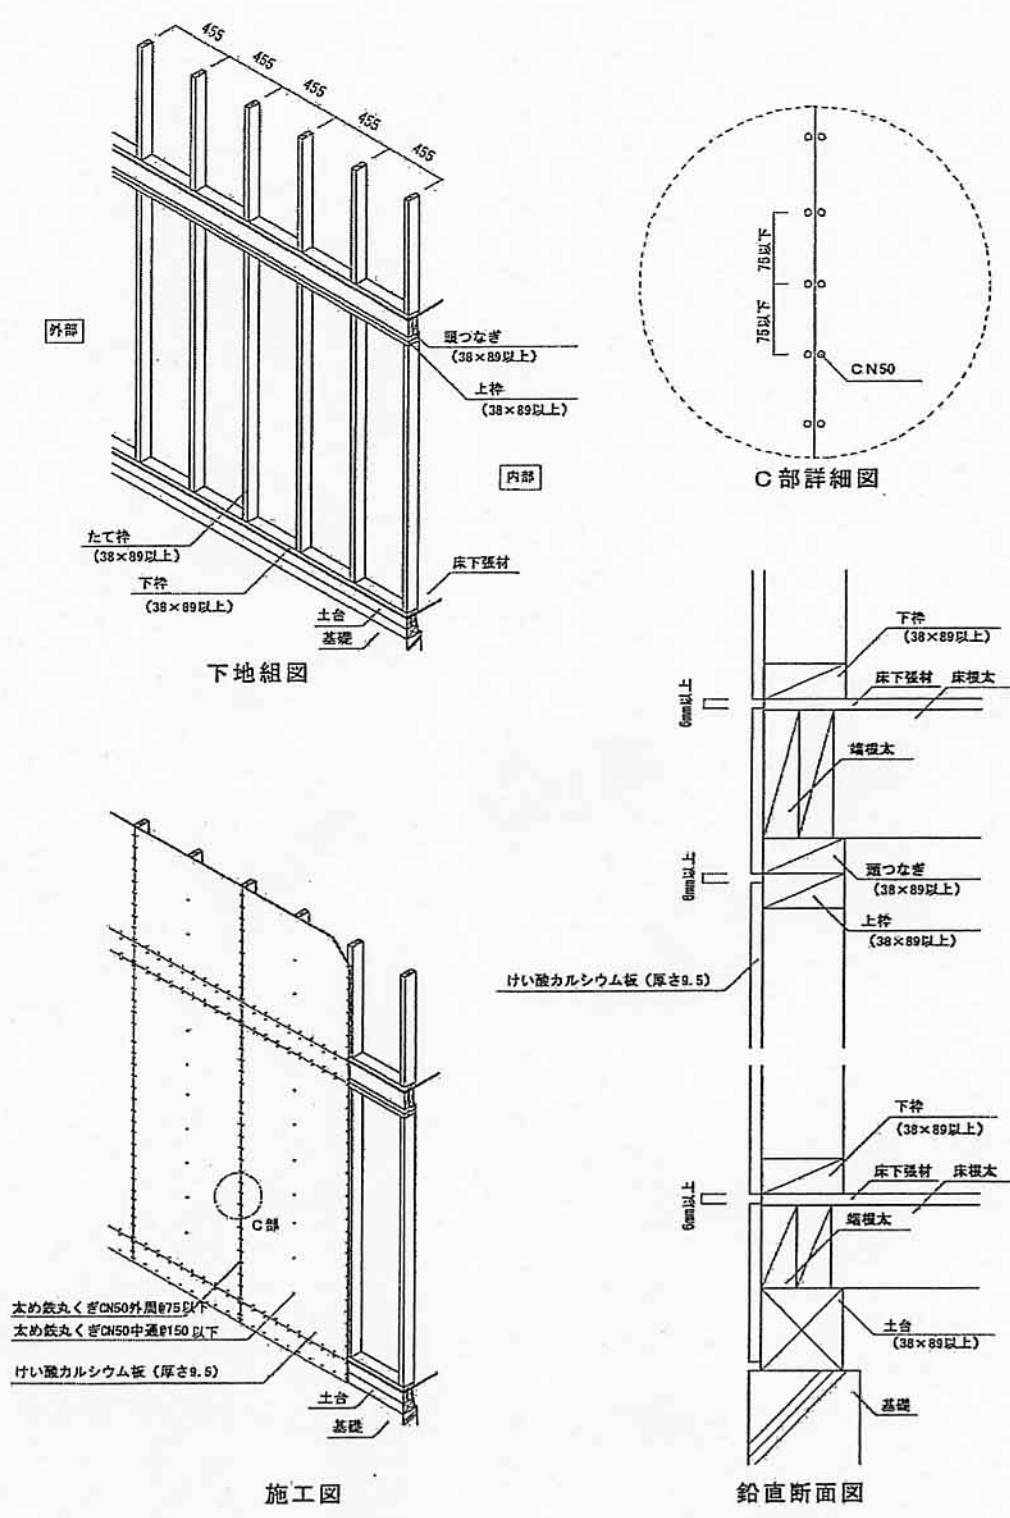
施工図：継手を設けない場合 (寸法単位：mm)
